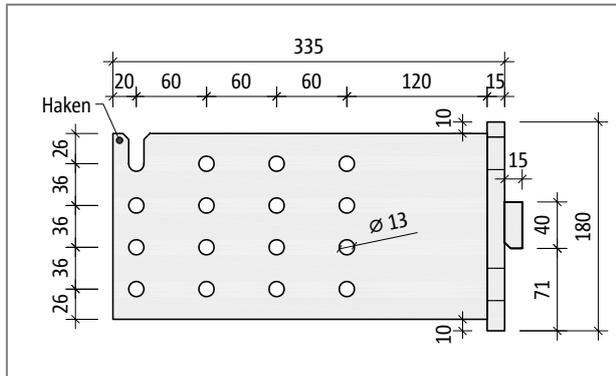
Schöck Isokorb® T Typ SK mit Stahlschwert: Stahlschwert
